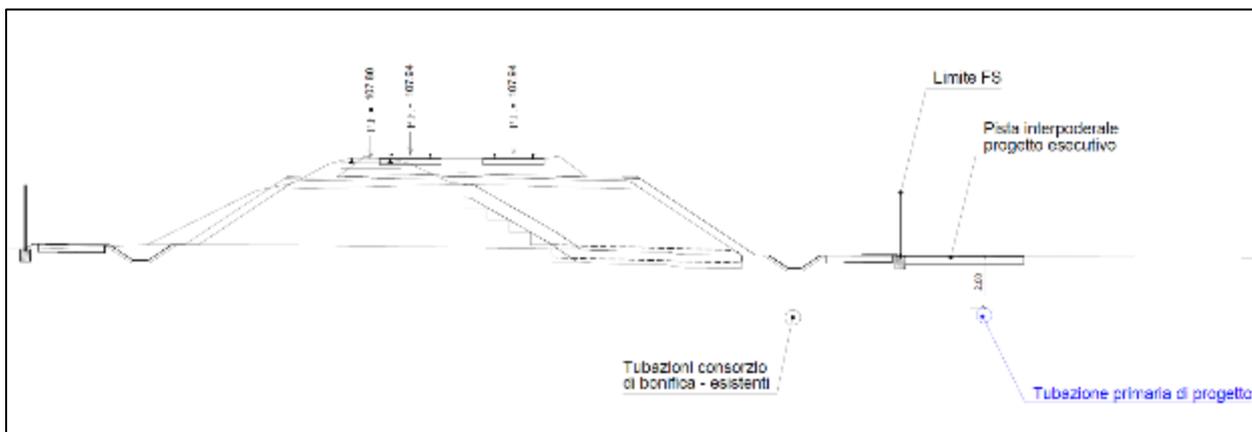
Spostamento tubazione: sezione tipo tubazione primaria
